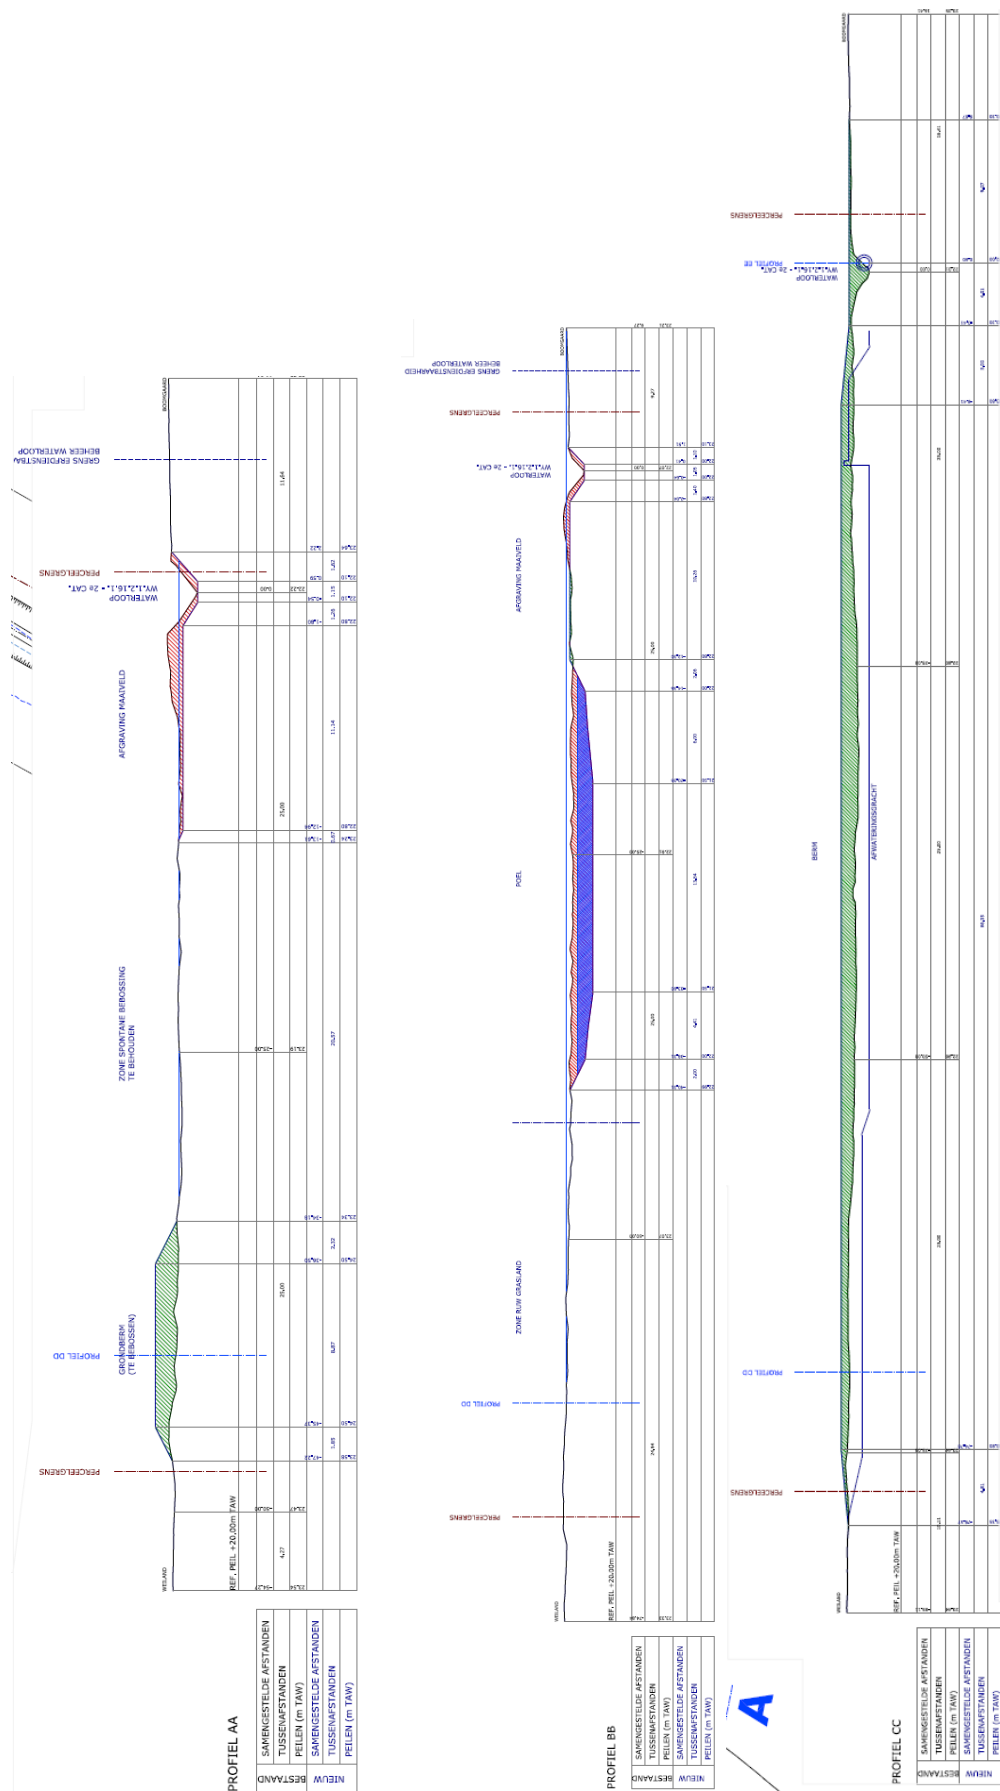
Opmetingsplan van de bestaande toestand (bron: opdrachtgever)
